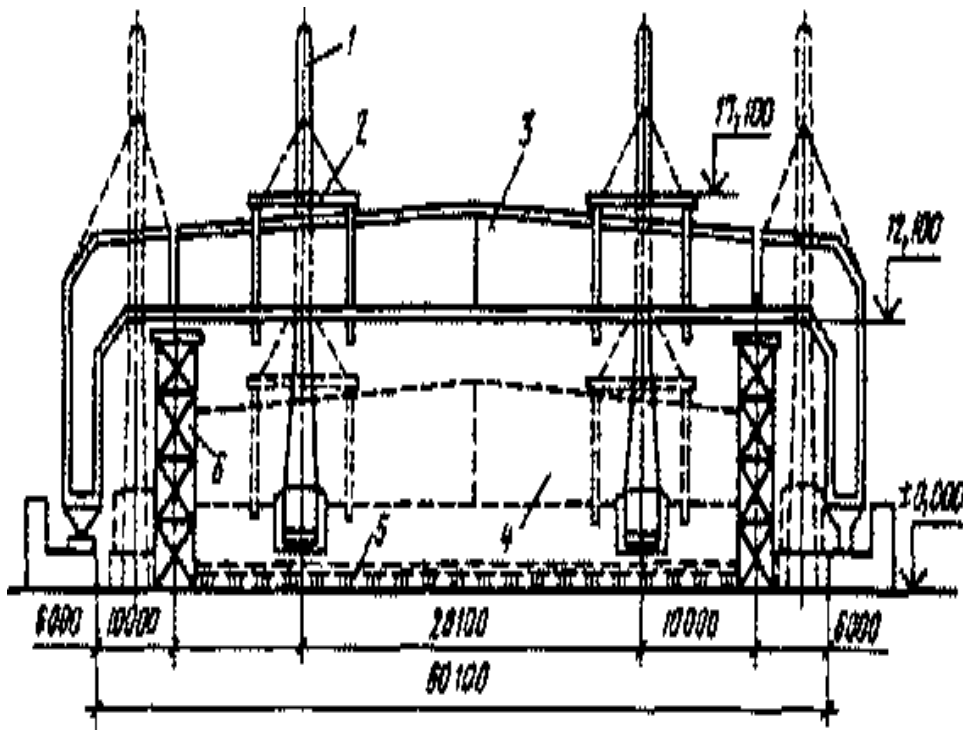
Варіант схеми монтажу покриття ангара рамної конструкції:
